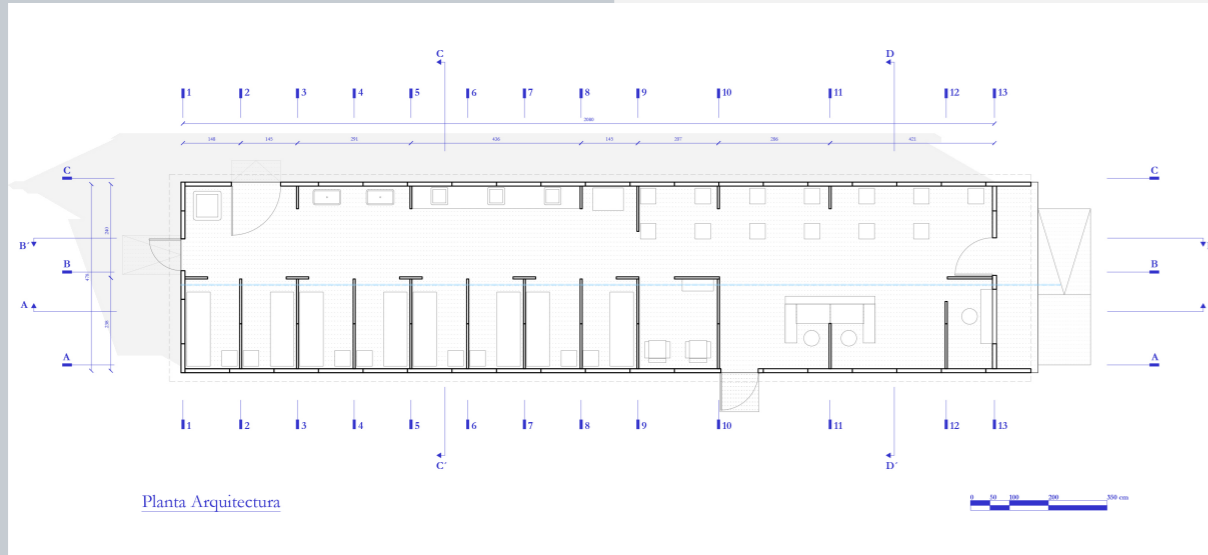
Planta de arquitectura proyecto ZonaCero Sinestesia
